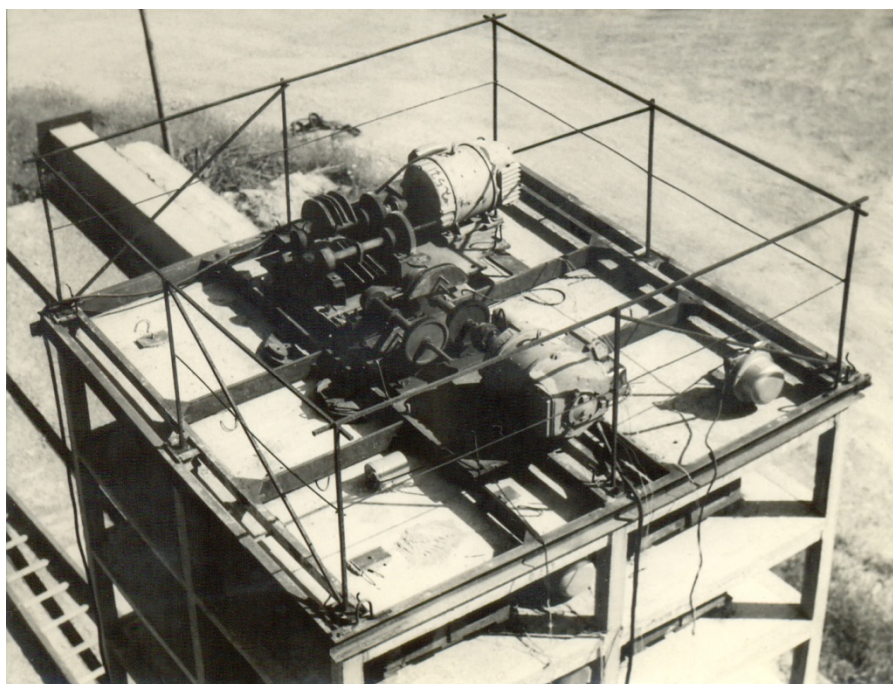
Лабораторные вибромашины для испытаний крупных моделей, установленные на перекрытии девятого этажа (до устройства гасителей) посредством стальной рамы, жестко закрепленной к стальным оголовникам колонн модели 9-этажного каркасного здания
